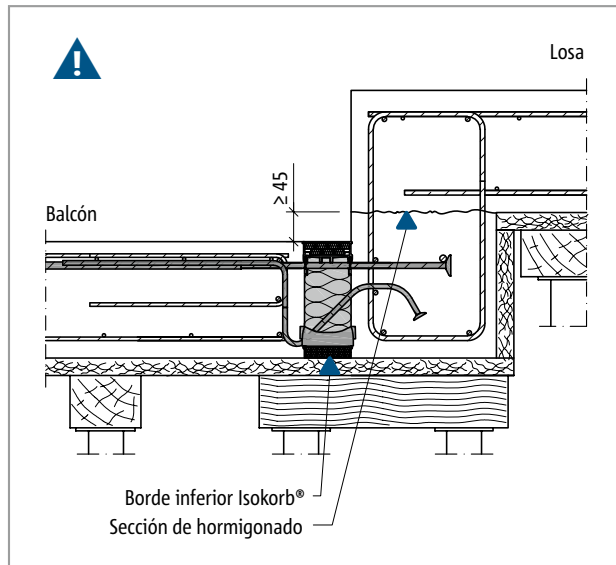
Schöck Isokorb® T tipo K-U: Balcón de hormigón in situ con desplazamiento de altura hacia abajo
